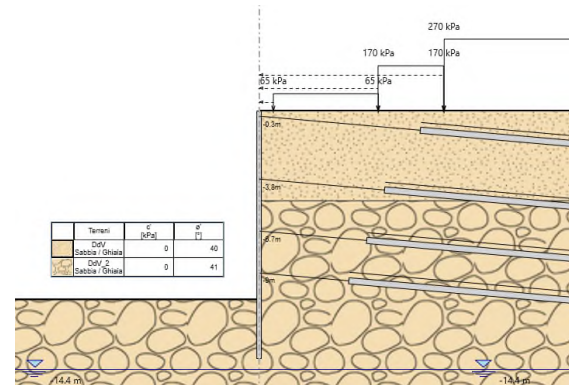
Raggiungimento fondo scavo (Stage 11)
